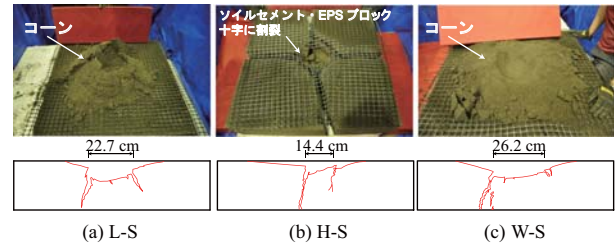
静載荷実験終了後における押抜きせん断コーンおよびEPSブロック断面のひび割れ状況
